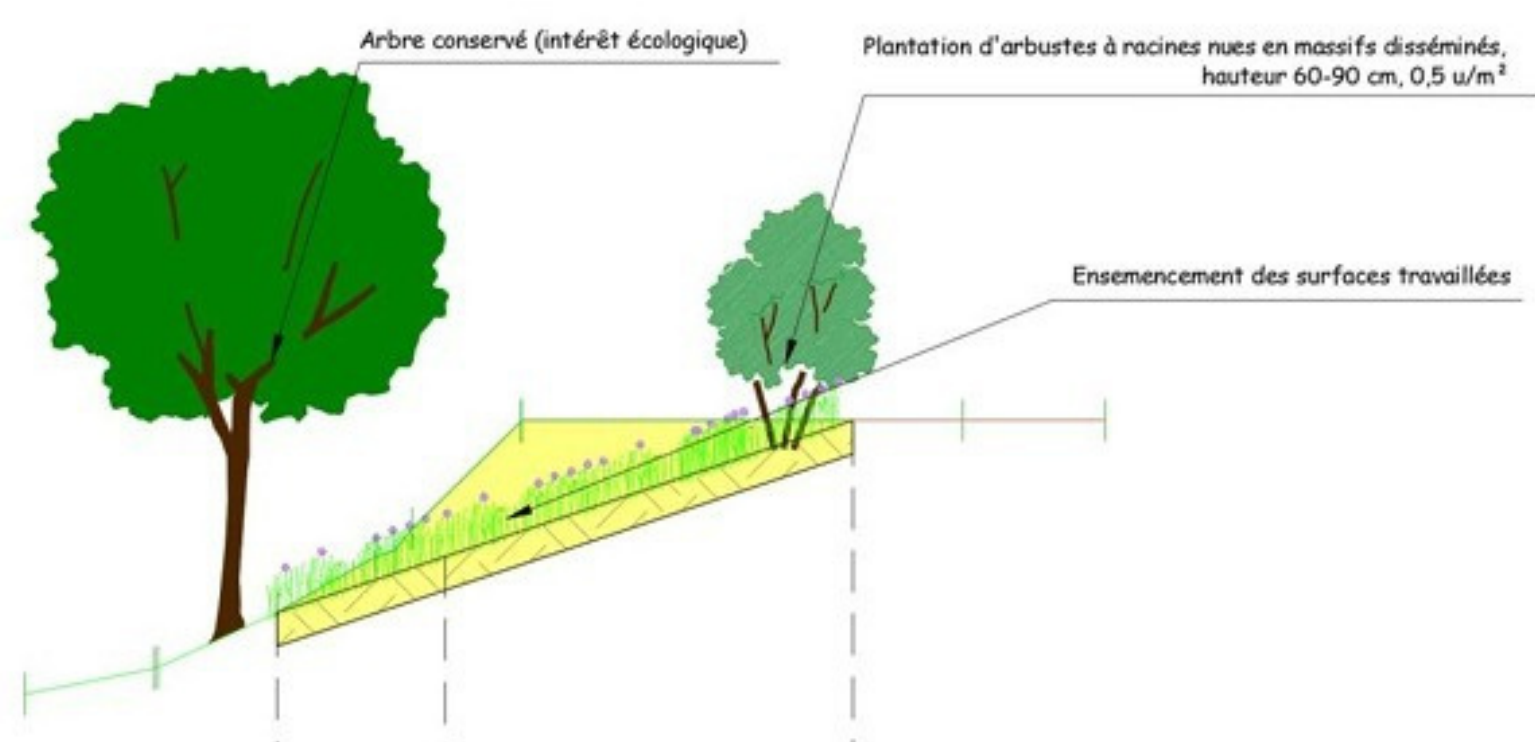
Coupe du reprofilage de la berge RD de la Mosson
